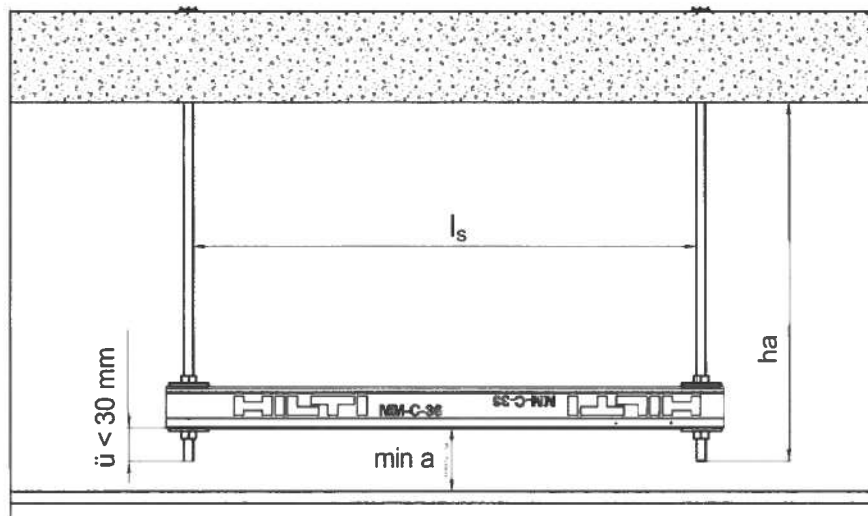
Graphische Darstellung der Anwendung von Hilti Schienenmontagesystemen MM im Zwischendeckenbereich abgehängter, brandschutztechnisch relevanter Unterdeckenkonstruktionen
